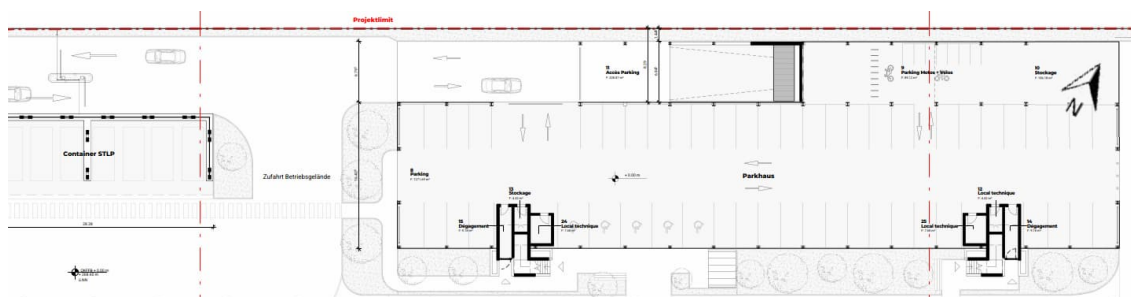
Plan d'implantation du parking silo – Parkhaus (WW+)
